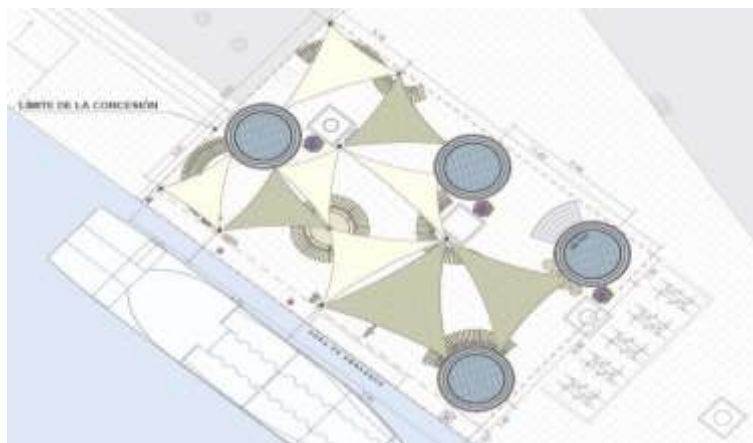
Escalera Real del Muelle de La Lonja. Planta de cubiertas
